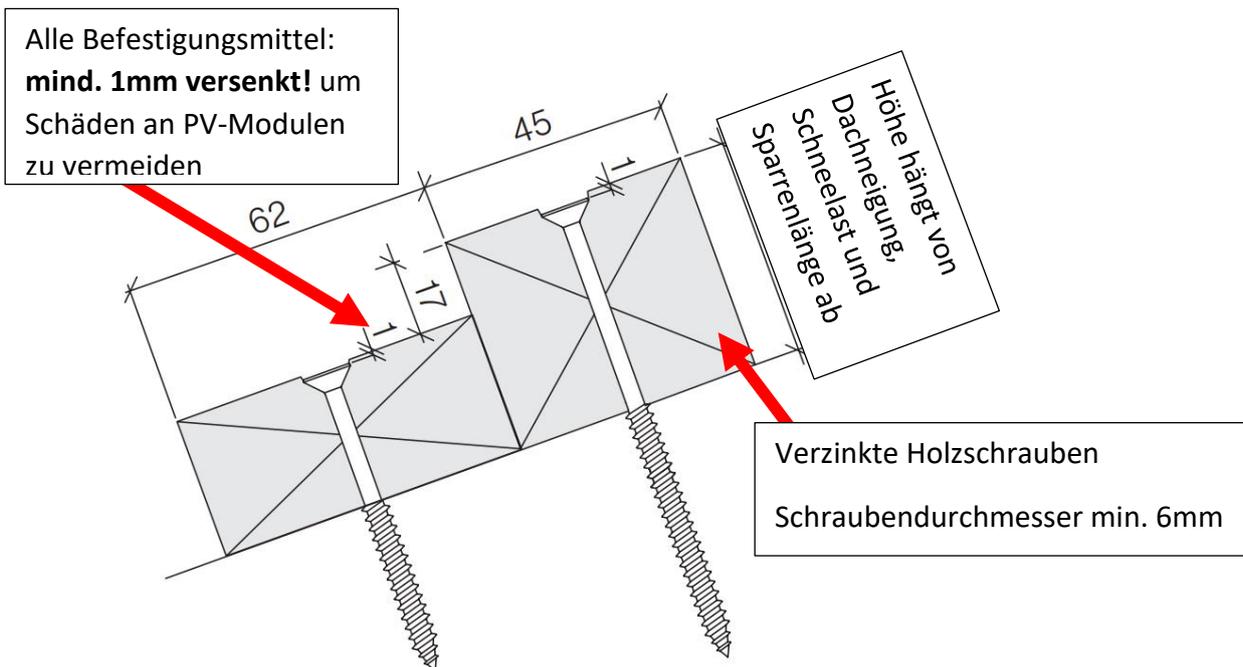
Dachlatten (Quelle: Swisspearl Details Sunskin Roof Lap)
